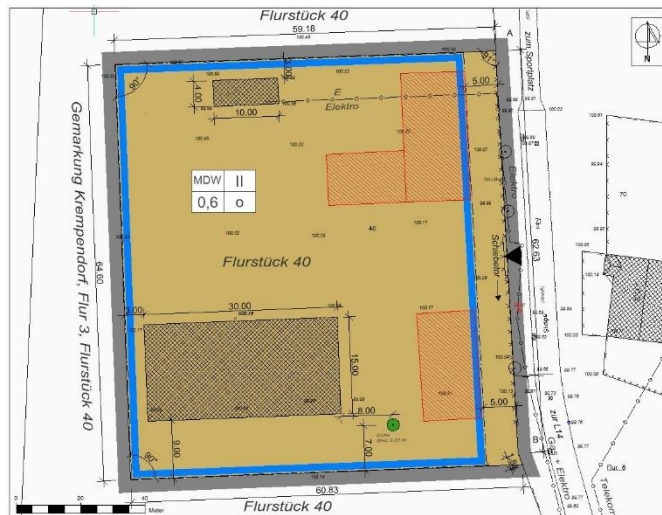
Darstellung des Geltungsbereiches zum Entwurf mit möglicher Gebäudeplanung
